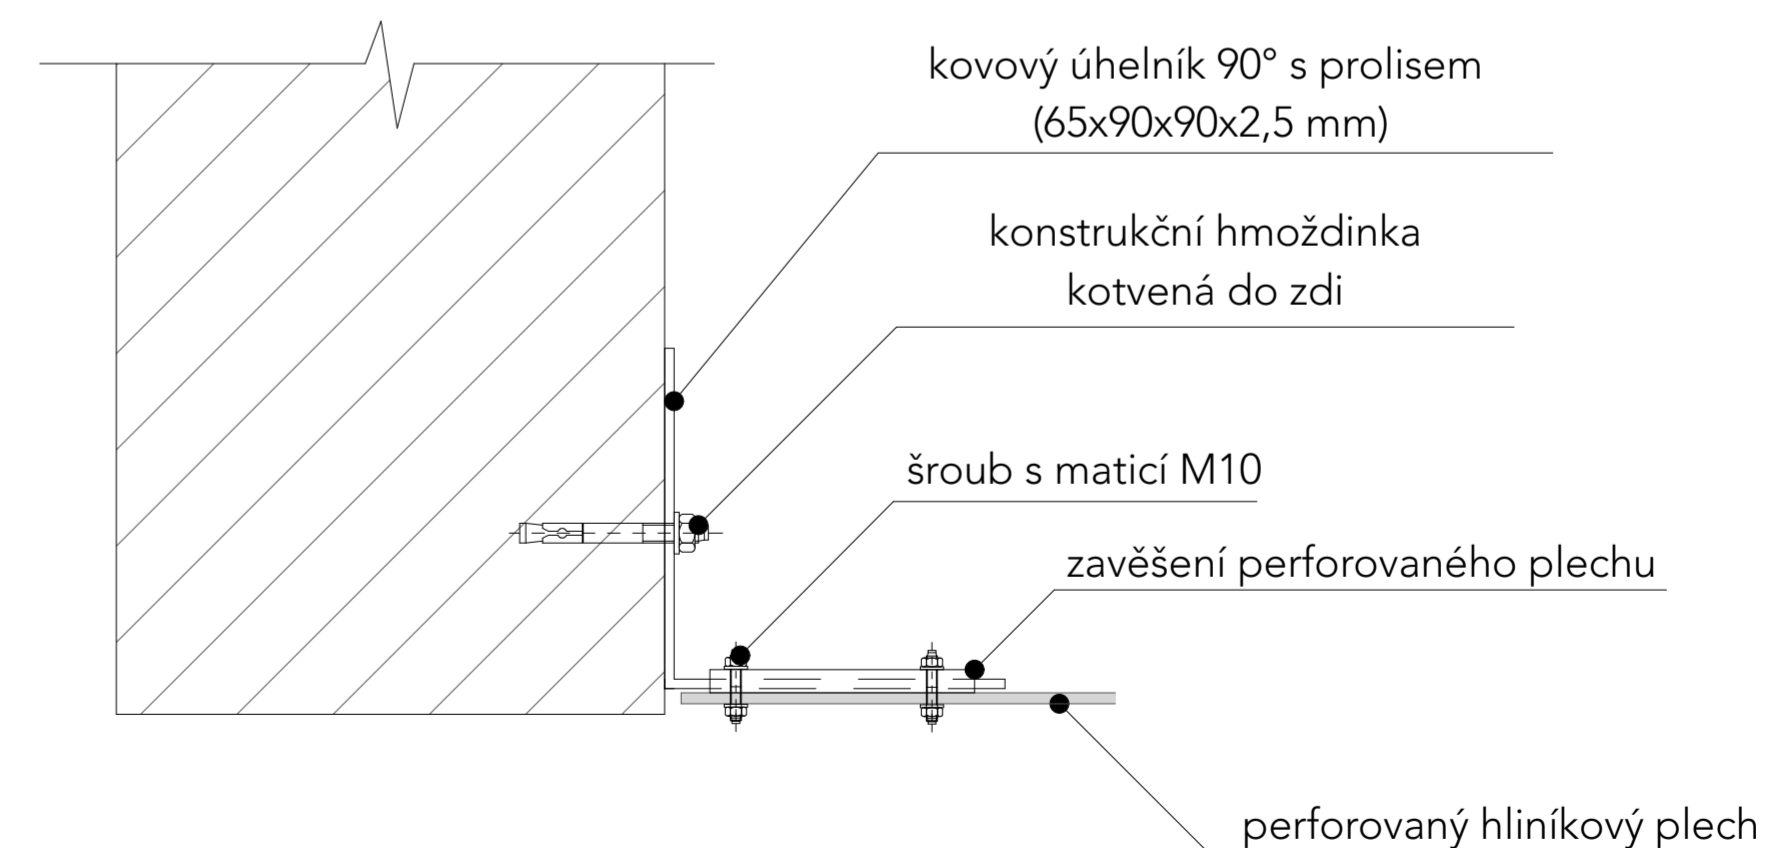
DETAIL ZÁSTĚNY - POHLED, PŮDORYS, KOTVENÍ KE STĚNĚ
